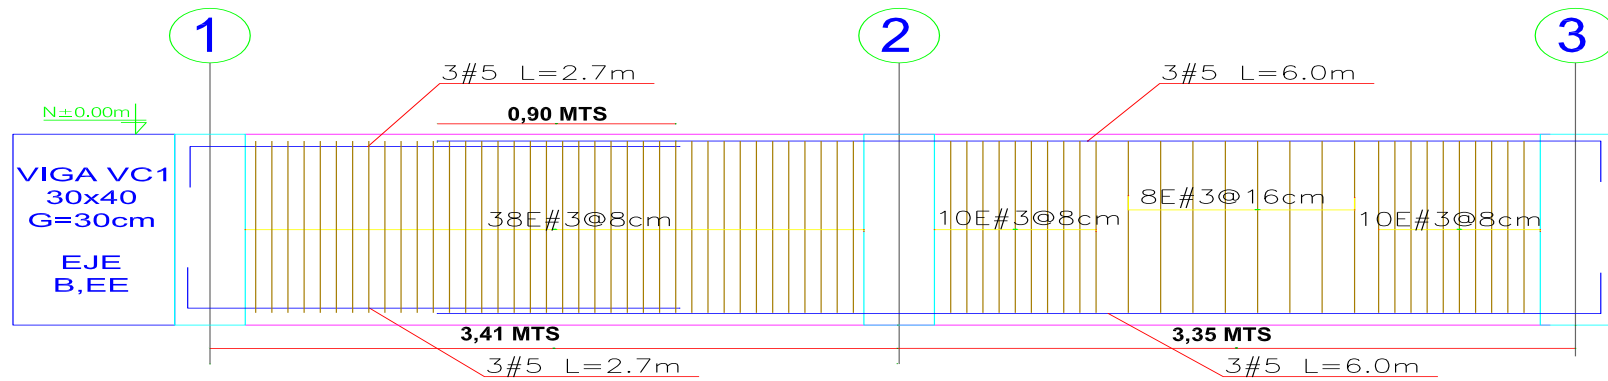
DESPIECE VIGA DE CIMENTACION VC1 EJE B, EE N 0,00m.
